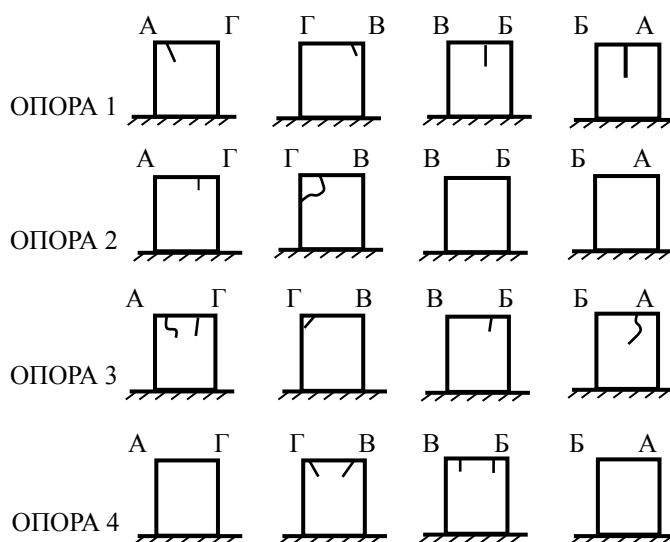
Схемы расположения трещин в опорных фундаментных столбах башни Жолболды
